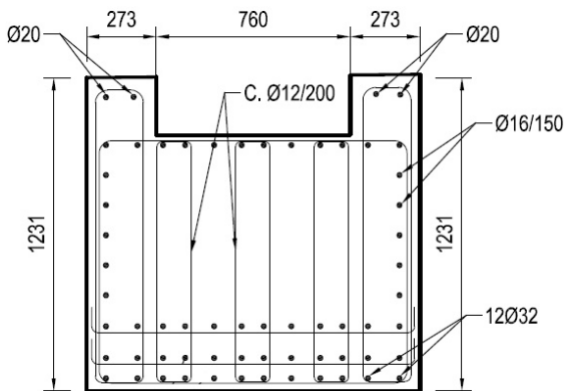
Esquema de armado transversal viga de junta entre cajones.
